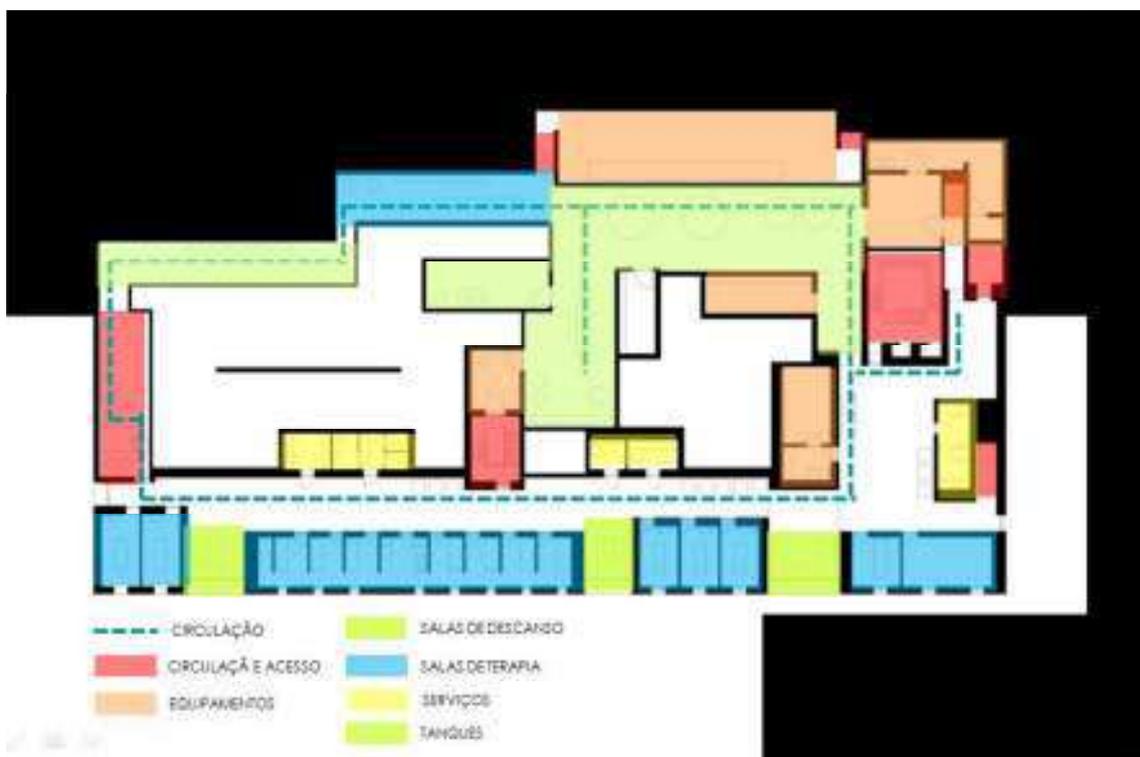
DIAGRAMA DA PLANTA DO PAVIMENTO SUPERIOR DO SPA
